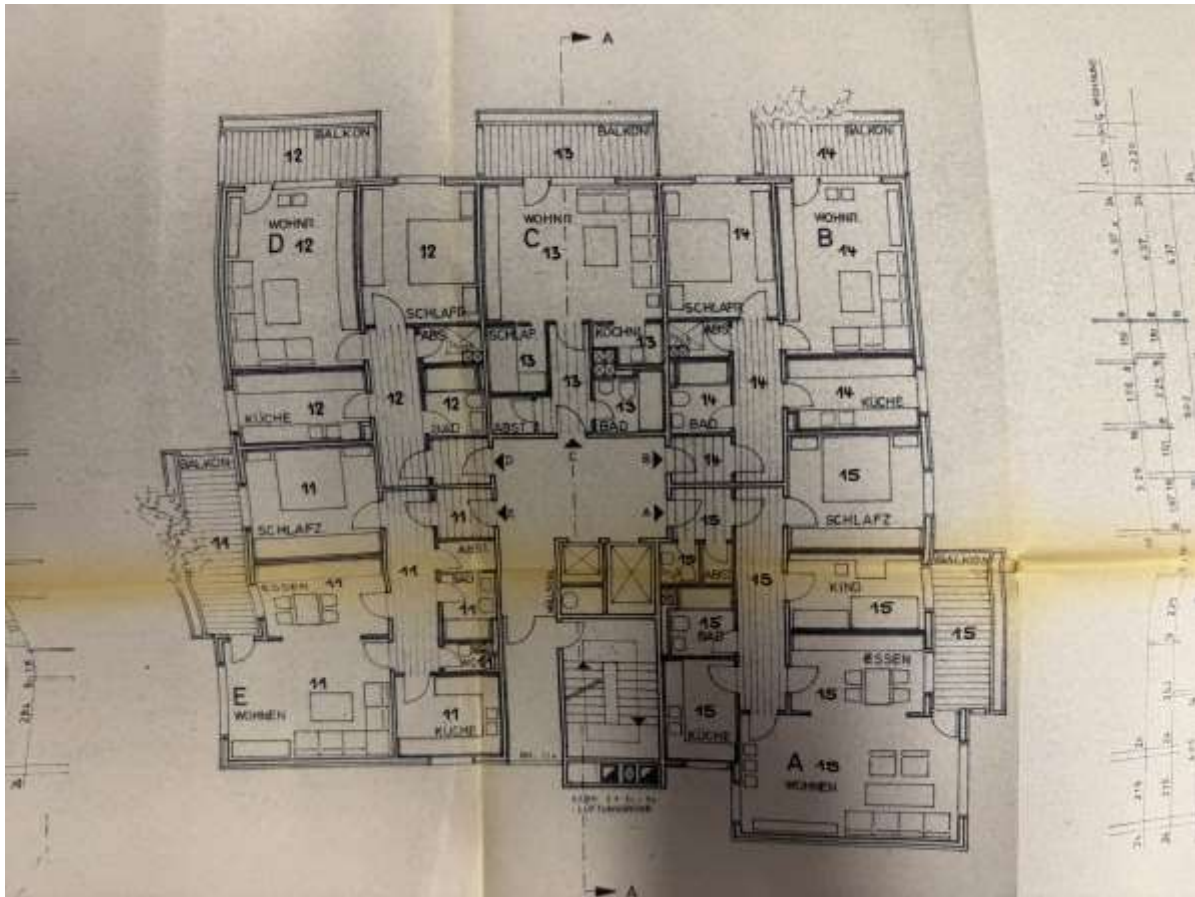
Grundriss SE 13 Quelle: Grundakte (Teilungserklärung)
